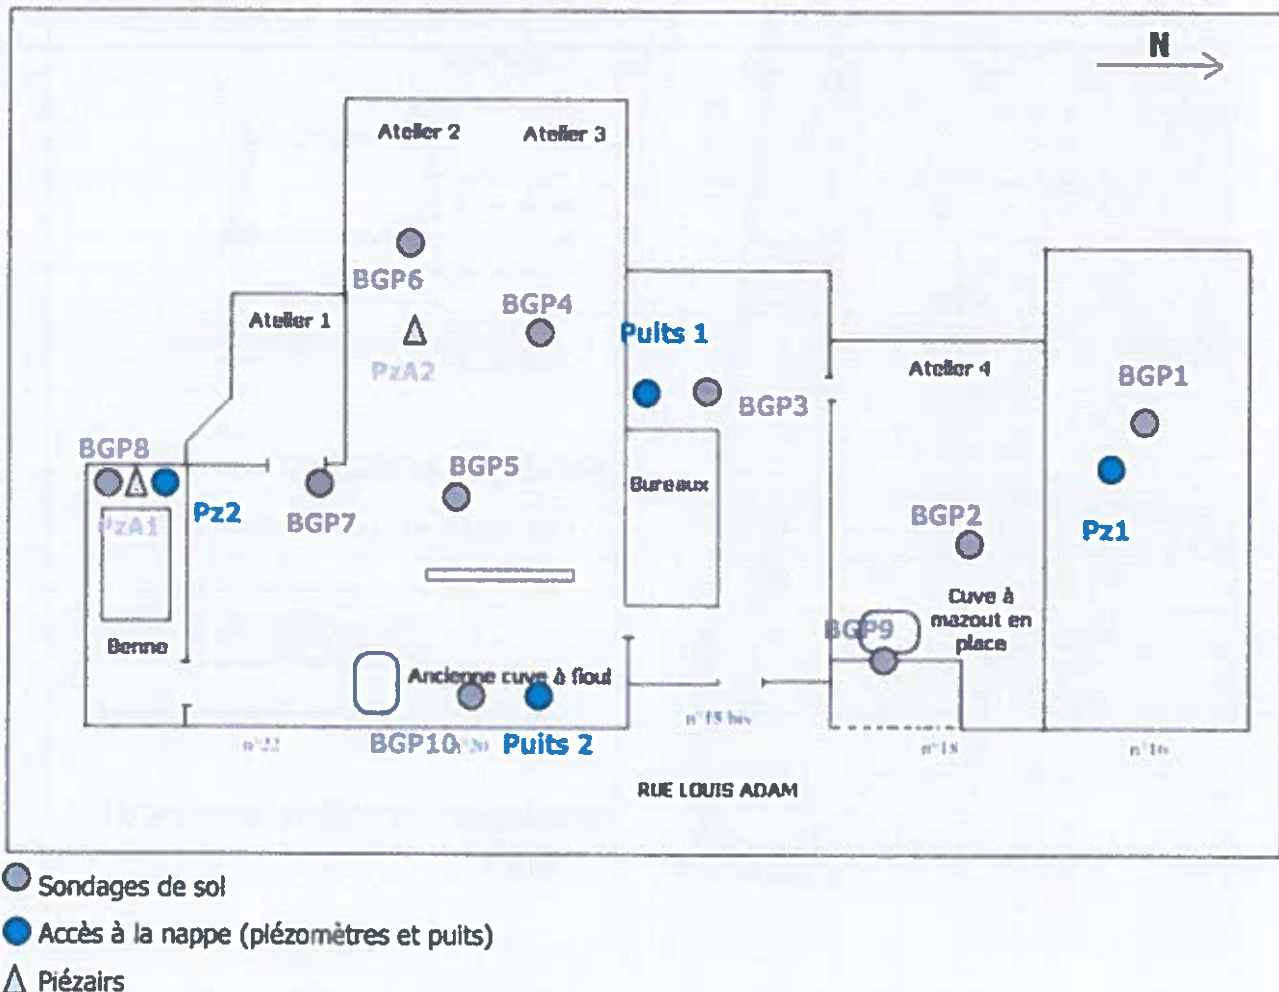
Plan d'implantation des piézomètres et piézairs.
